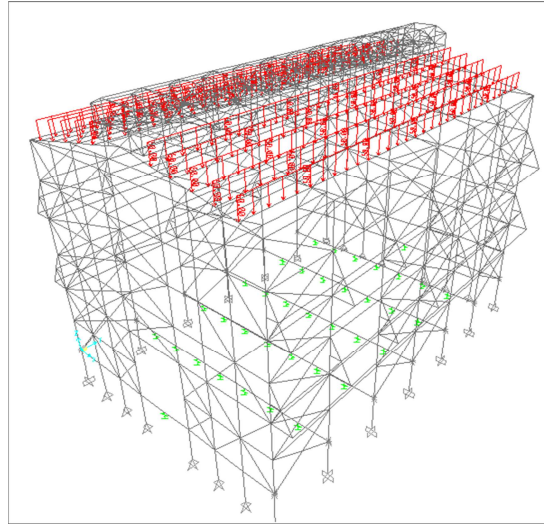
Carga viva (CV) aplicadas a la forma estructural.
